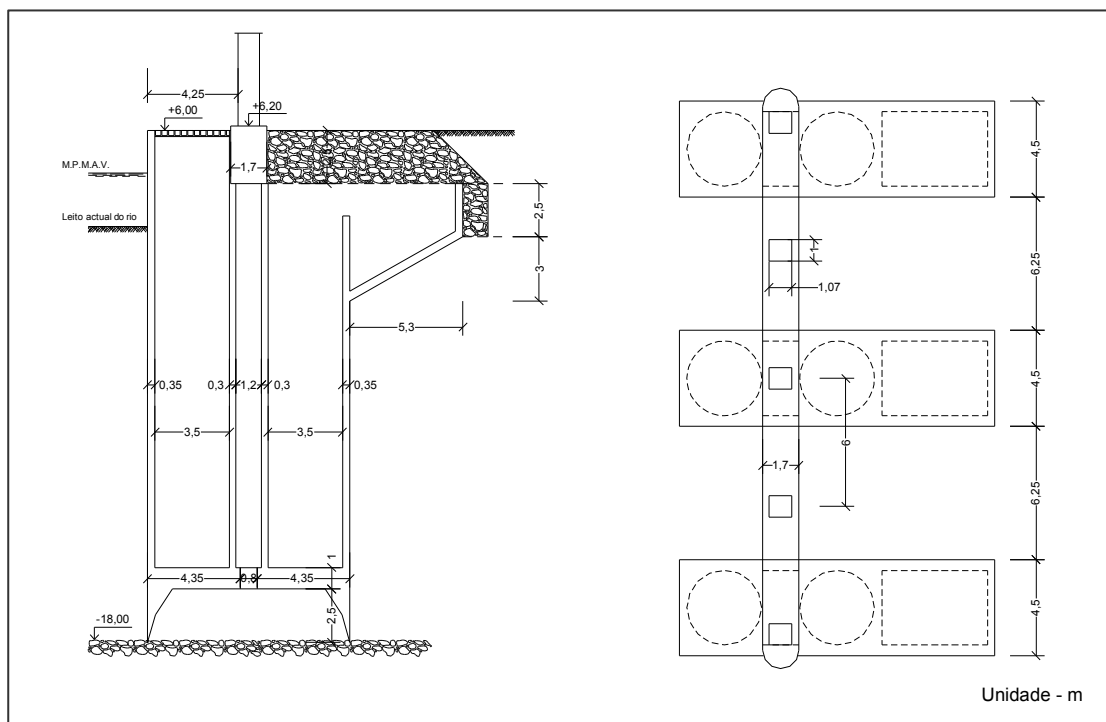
Corte e planta das fundações dos pórticos adjacentes ao rio Leça do viaduto da Via Rápida.
